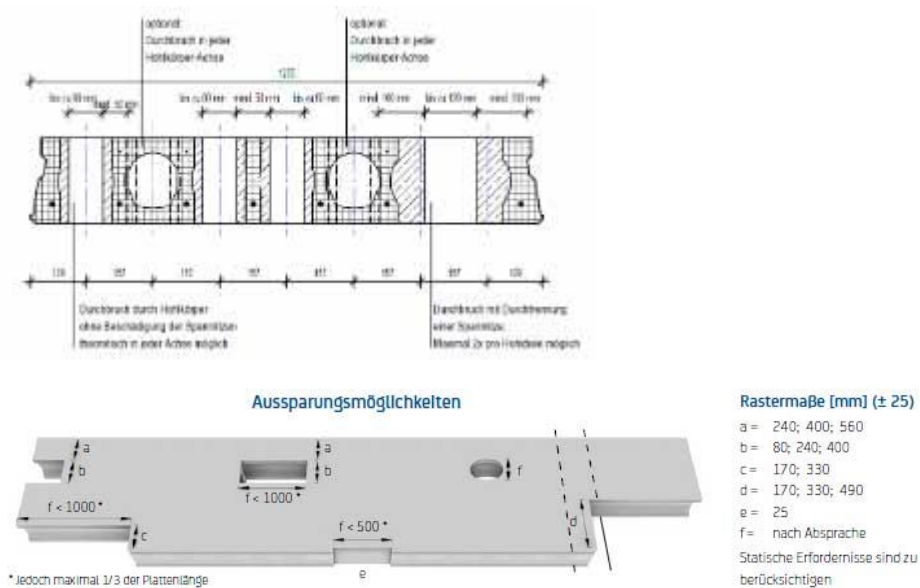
Schema mögliche Durchbrüche in einer Spannbeton-Hohlplatte mit 7 Hohlkammern, [ACMS Architekten GmbH]
